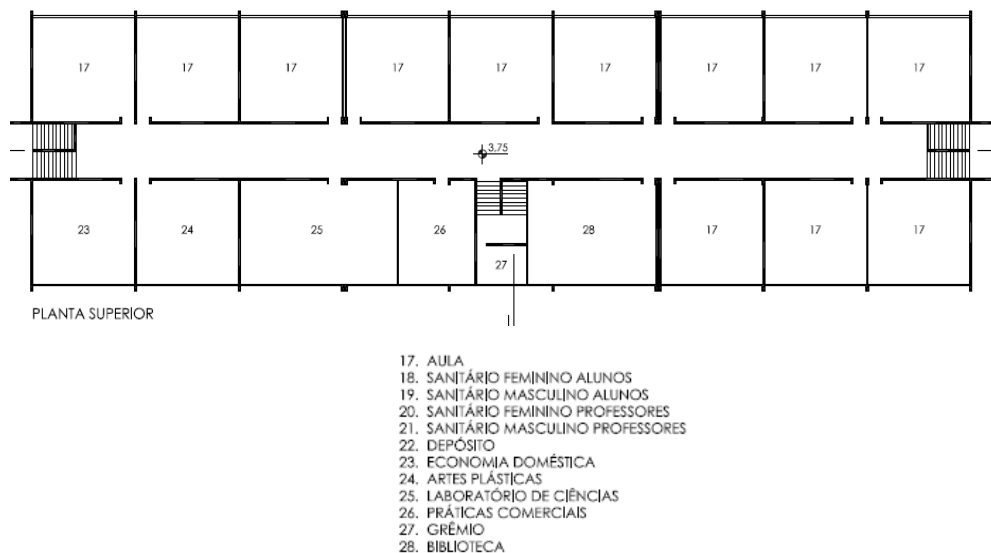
Planta do pavimento superior do centro educacional projetado em 1970 pelo arquiteto Djalma Cintra de Andrade. Fonte: Mello (2012)
